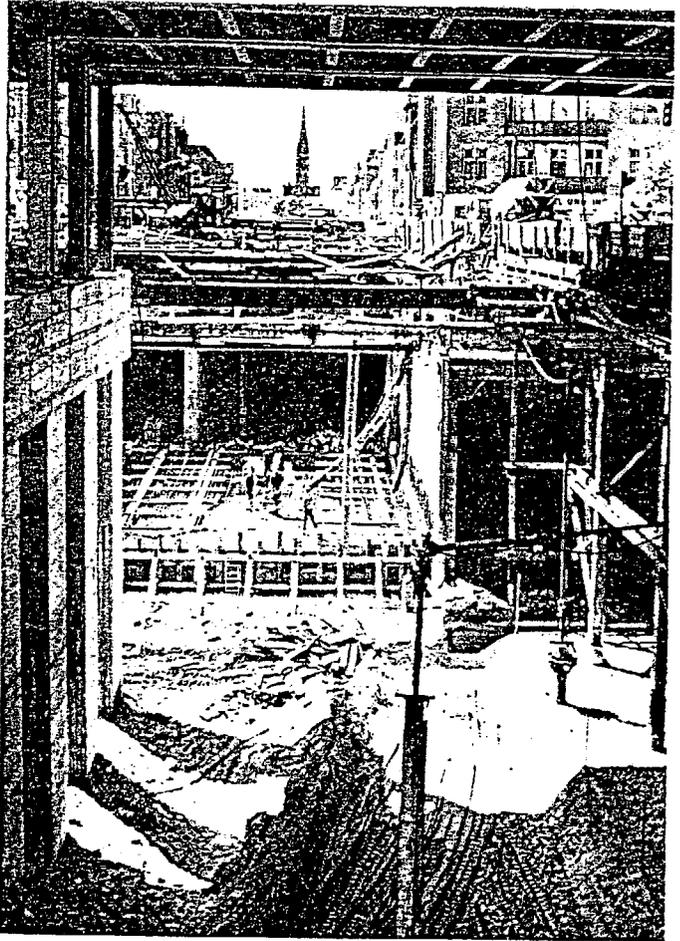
Baustelle des U-Bahnhofs Bundesplatz und des Straßentunnels mit Blick nach Süden.
